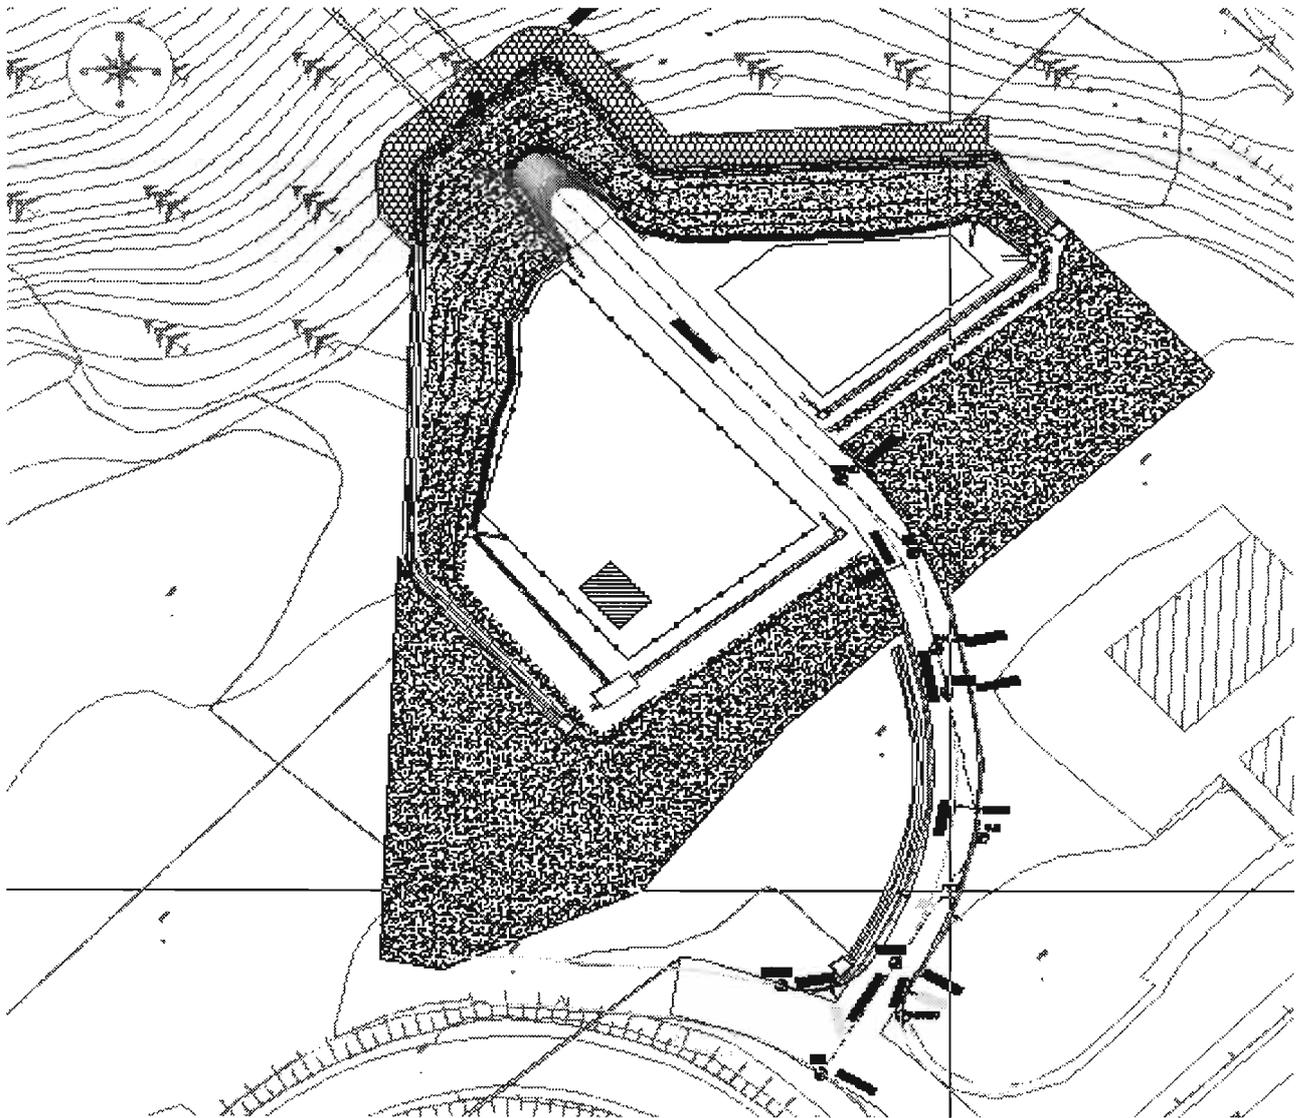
Schema planimetrico Cantierizzazione Albes Fase Definitiva
